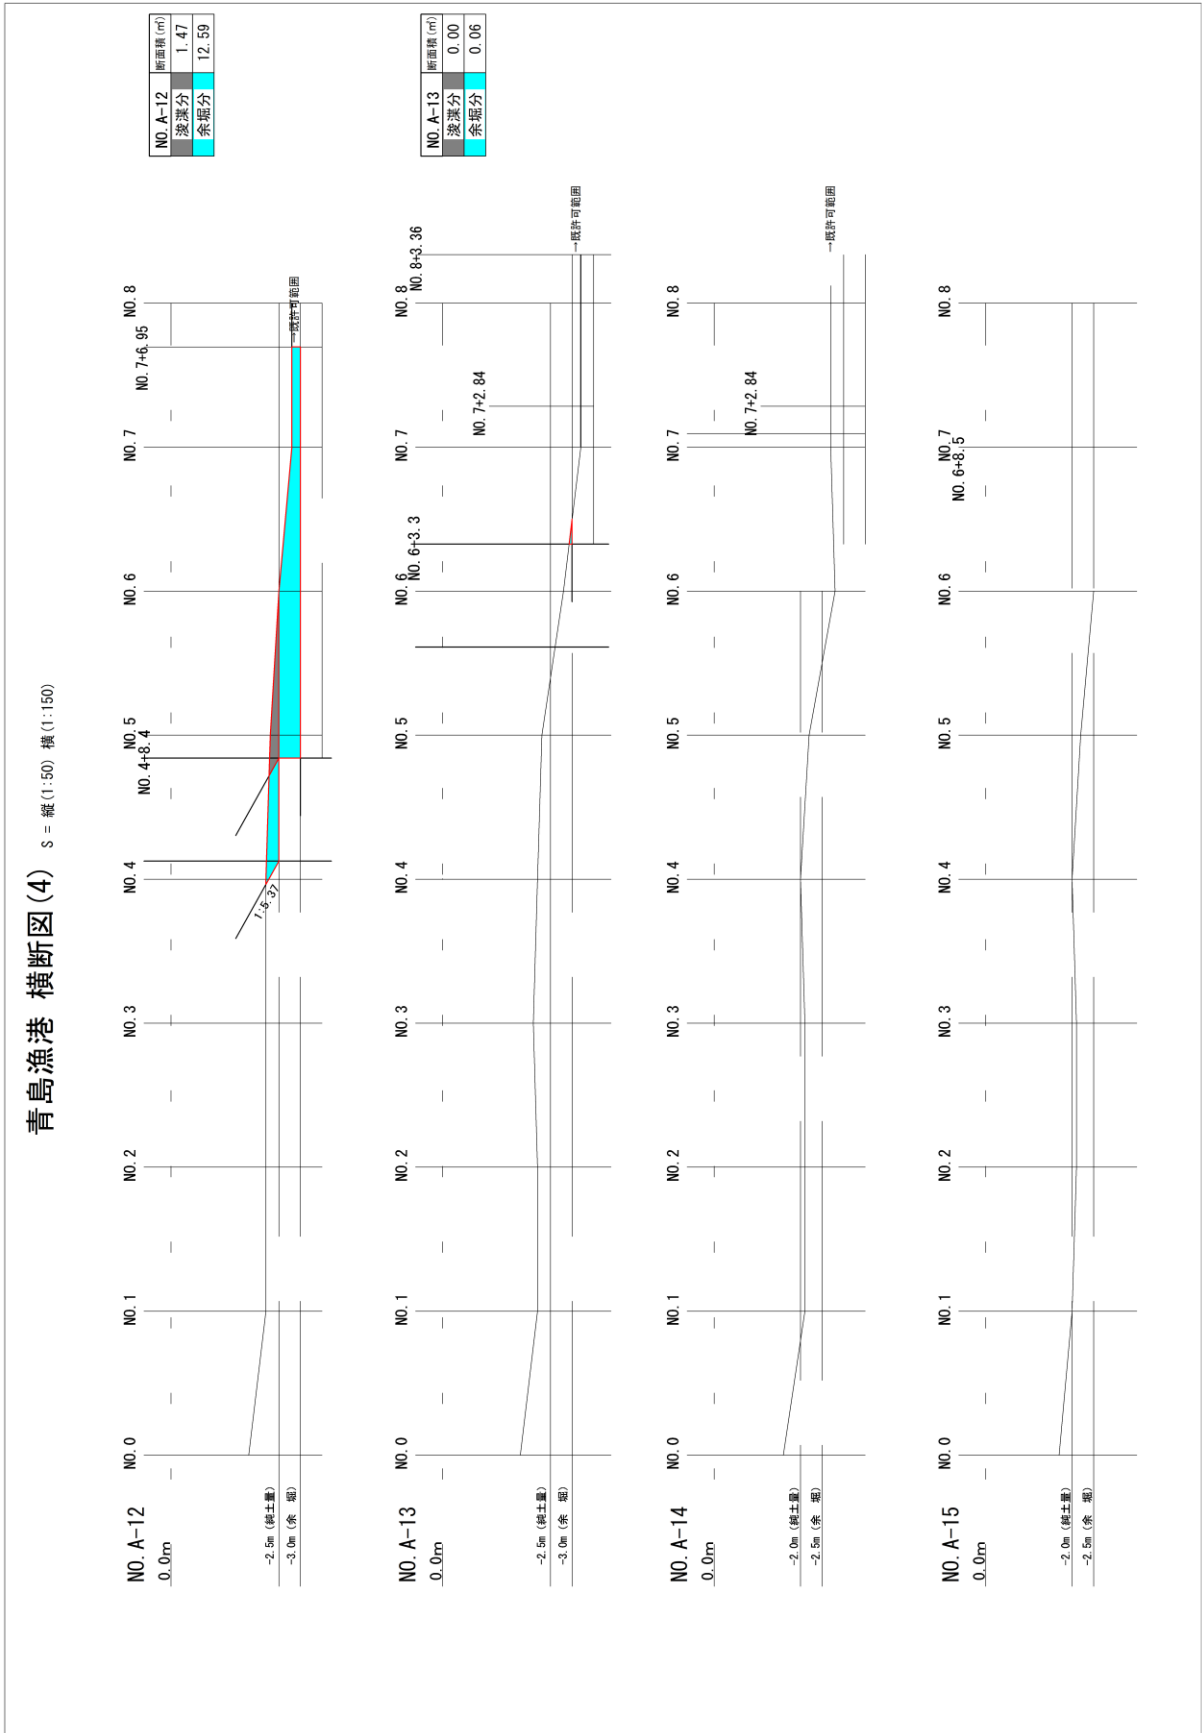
(4) 横断面图 (測線 No. A-12~A-15)
